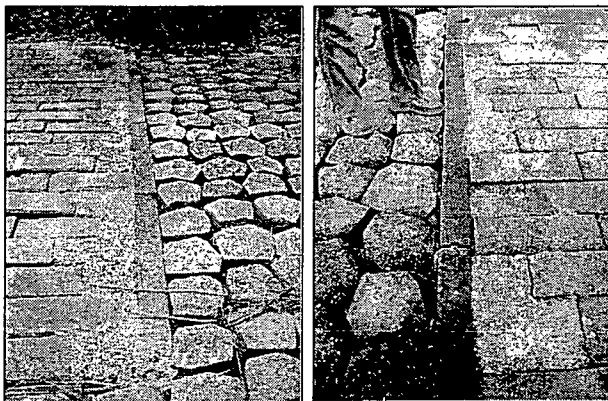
en 1b: overgangsconstructie met rechte betonbanden
